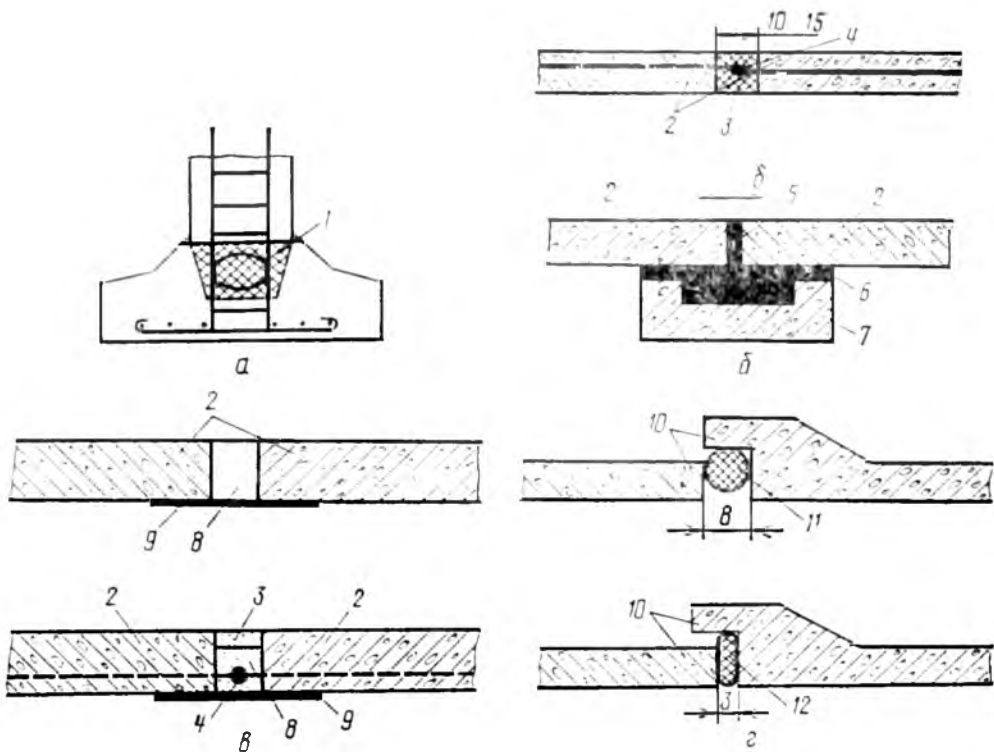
Конструкции стыков сборных железобетонных элементов:
